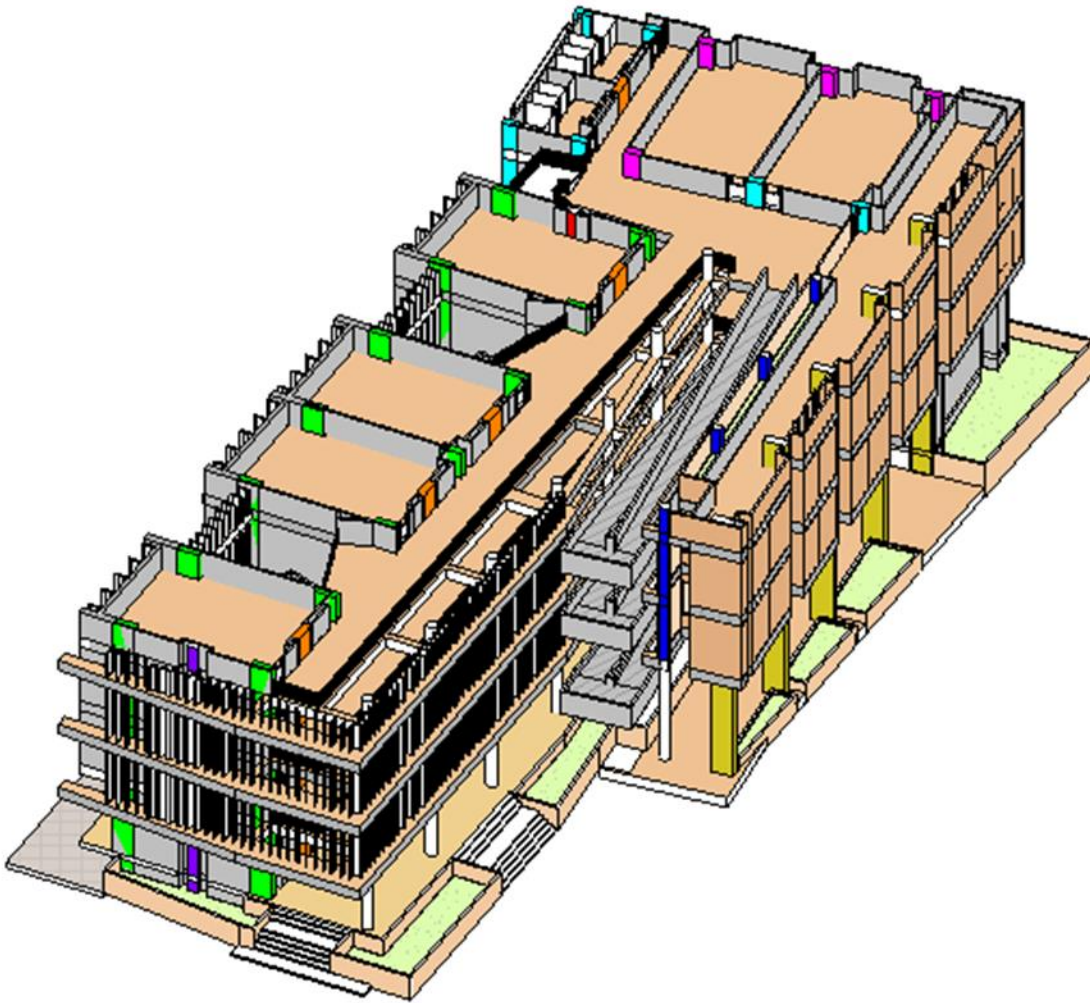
Vista Sección Arquitectónica planta N° 4.
